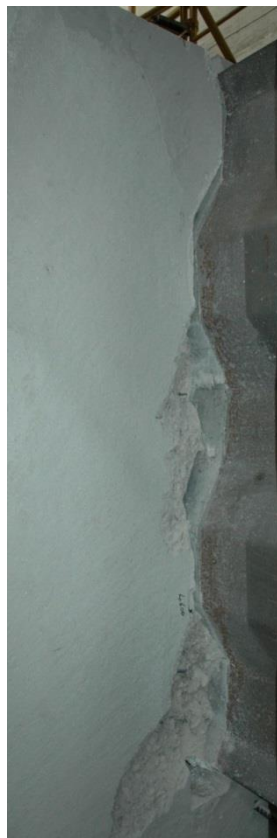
Betonausbruch (5a) innen in den Sicken des Trapezbleches bei Körper KBD3-2
